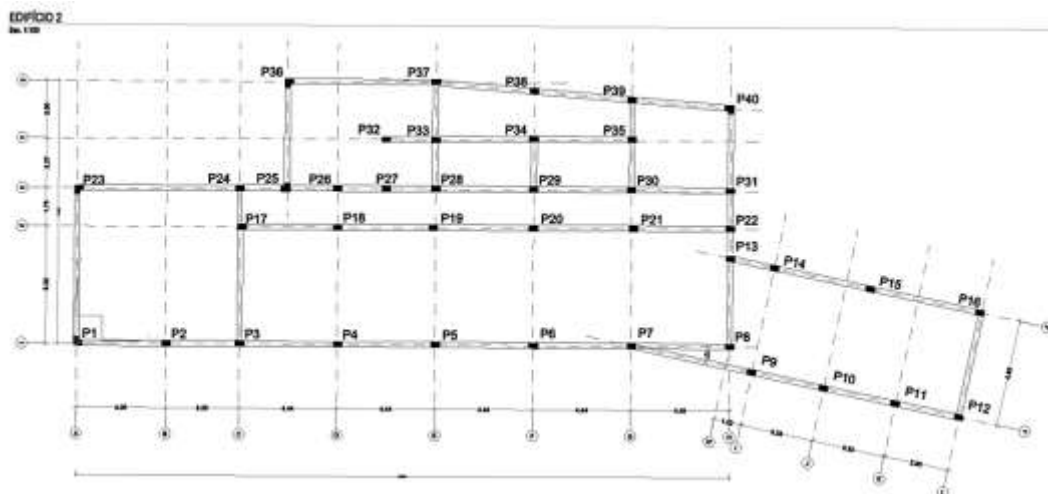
Planta do piso 0 da estrutura dimensionada a implementar o sistema de isolamento.
